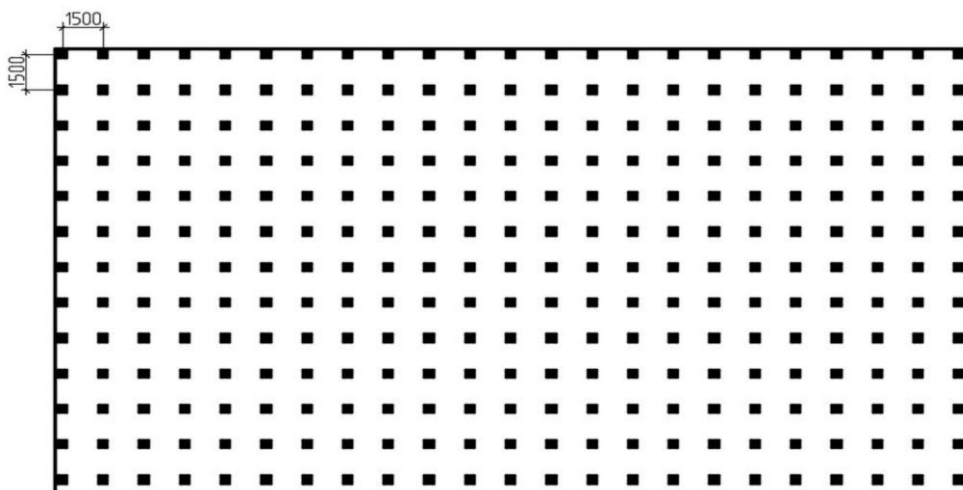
Опалубне креслення монолітної плити фундаменту
